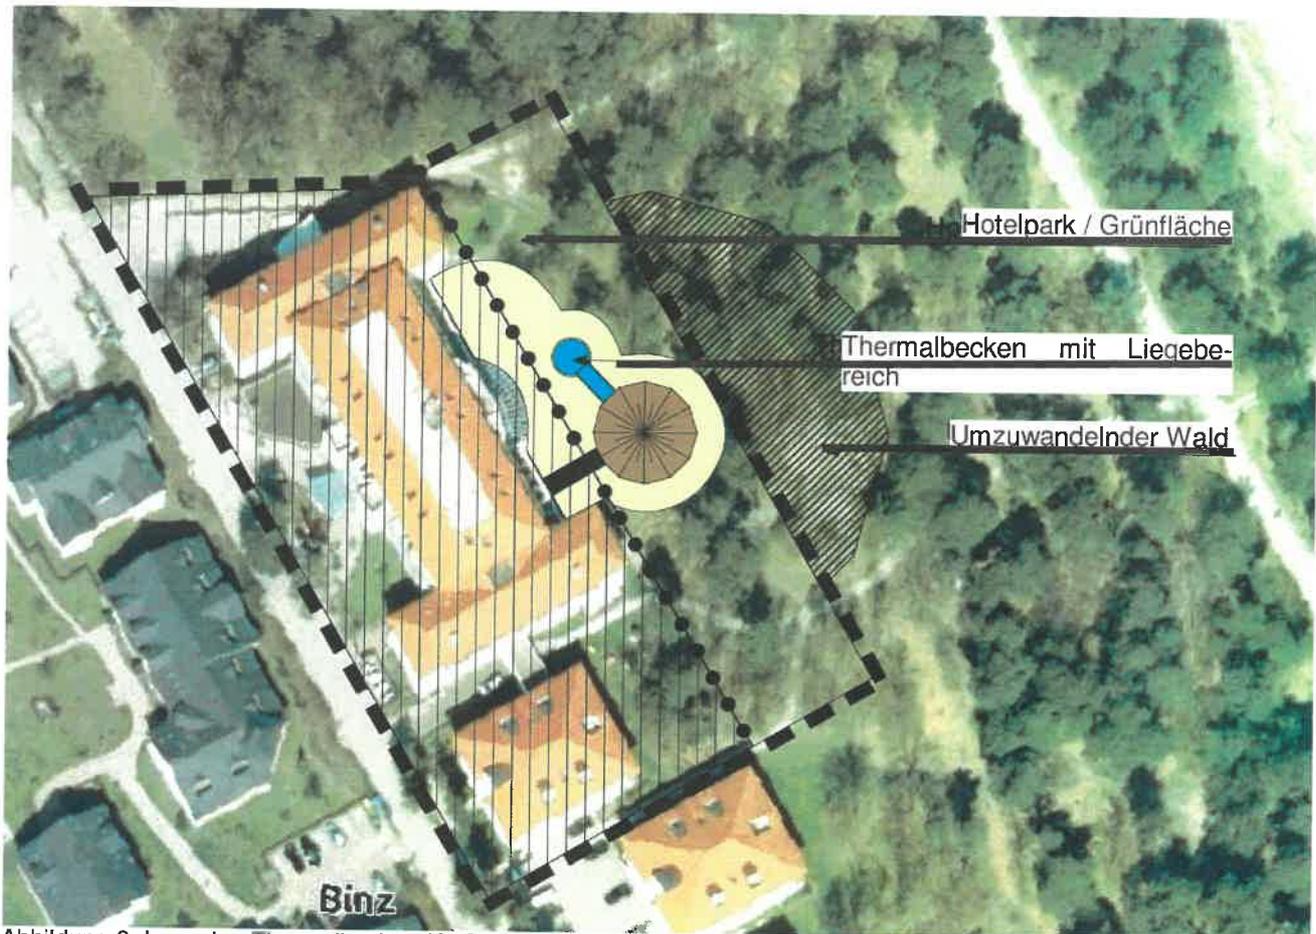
Lageplan Thermalbecken (Außenbecken und Schwimmhalle)
